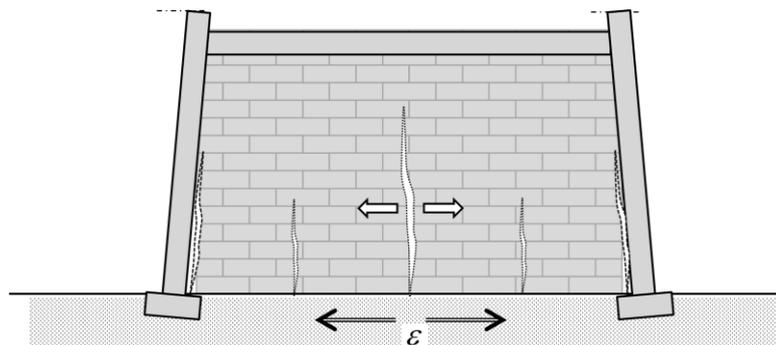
exemple de fissures verticales induites par la déformation horizontale du terrain
